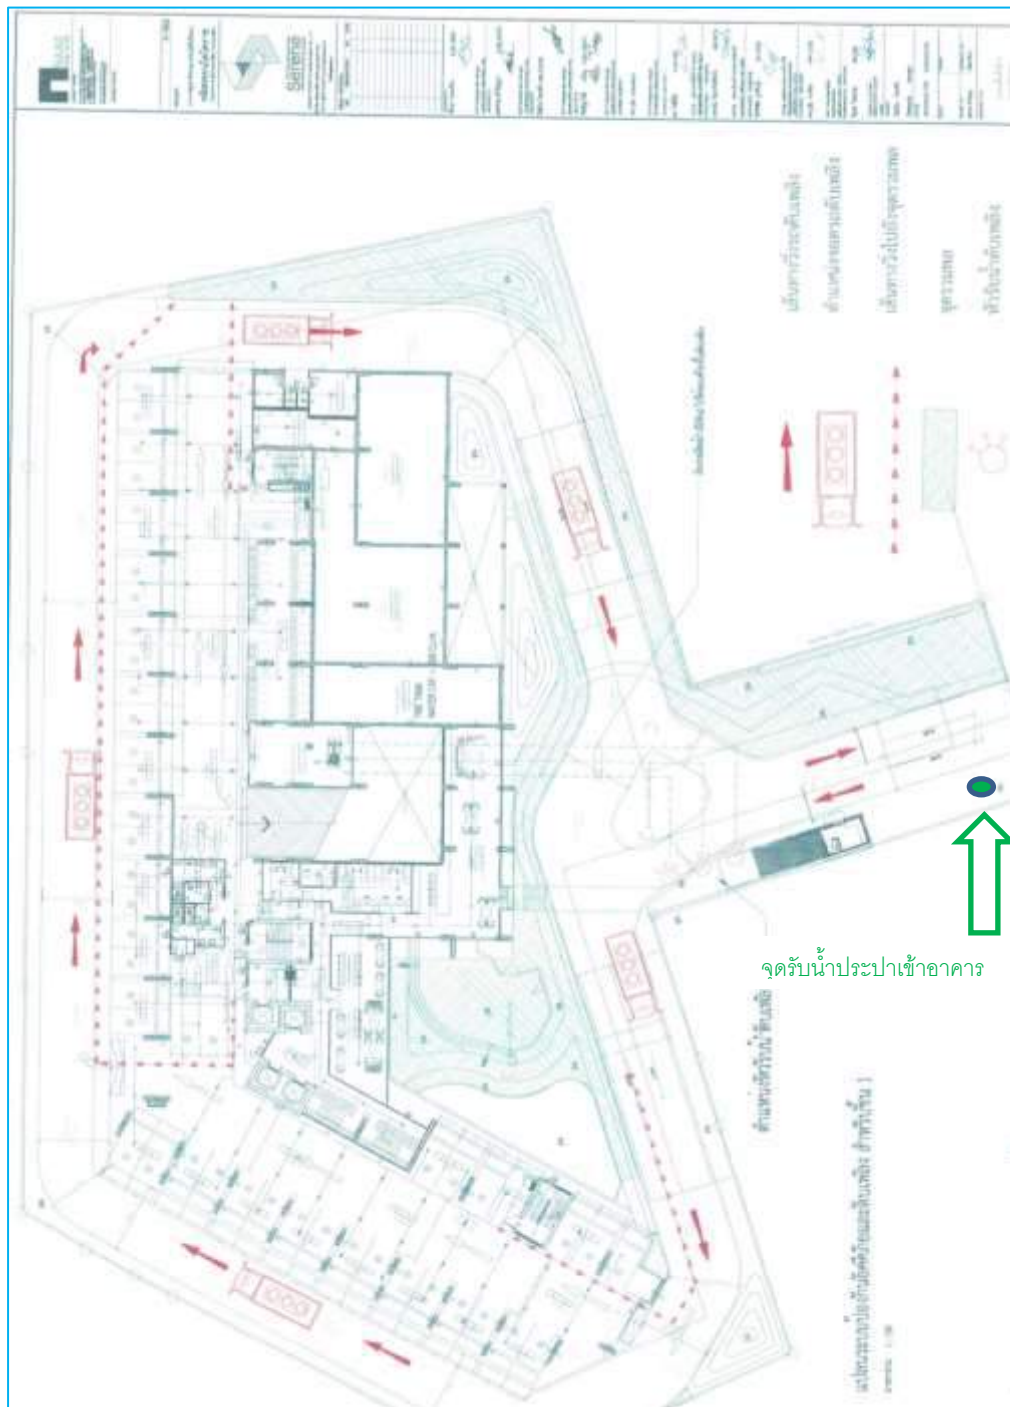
ผังบริเวณโครงการ
